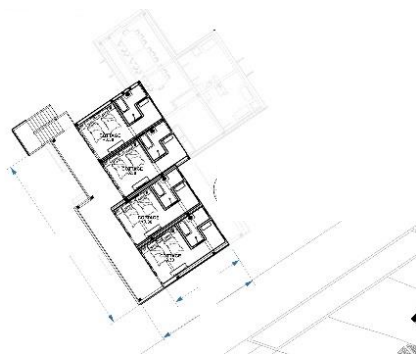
8 Denah lantai -2 (Zona Penerima dan Area Makan)
